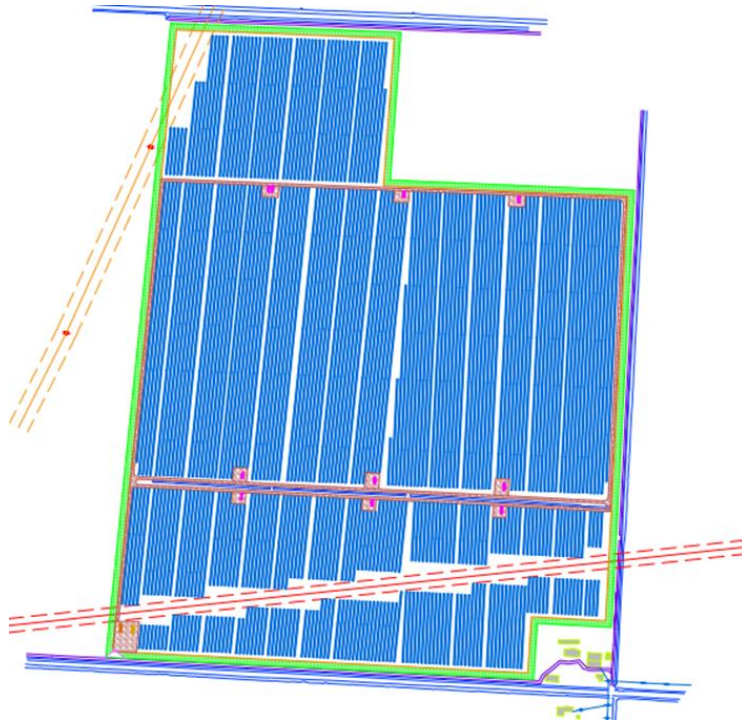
Layout campo Ovest dell'impianto fotovoltaico
